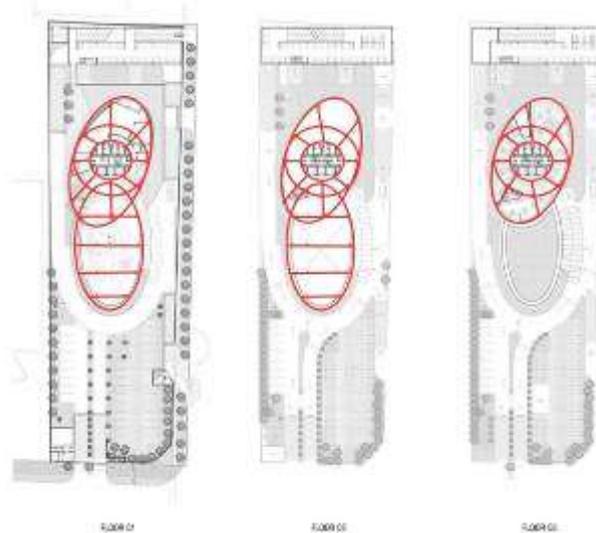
Material Struktur Kolom dan Balok Gedung Avian, Surabaya
